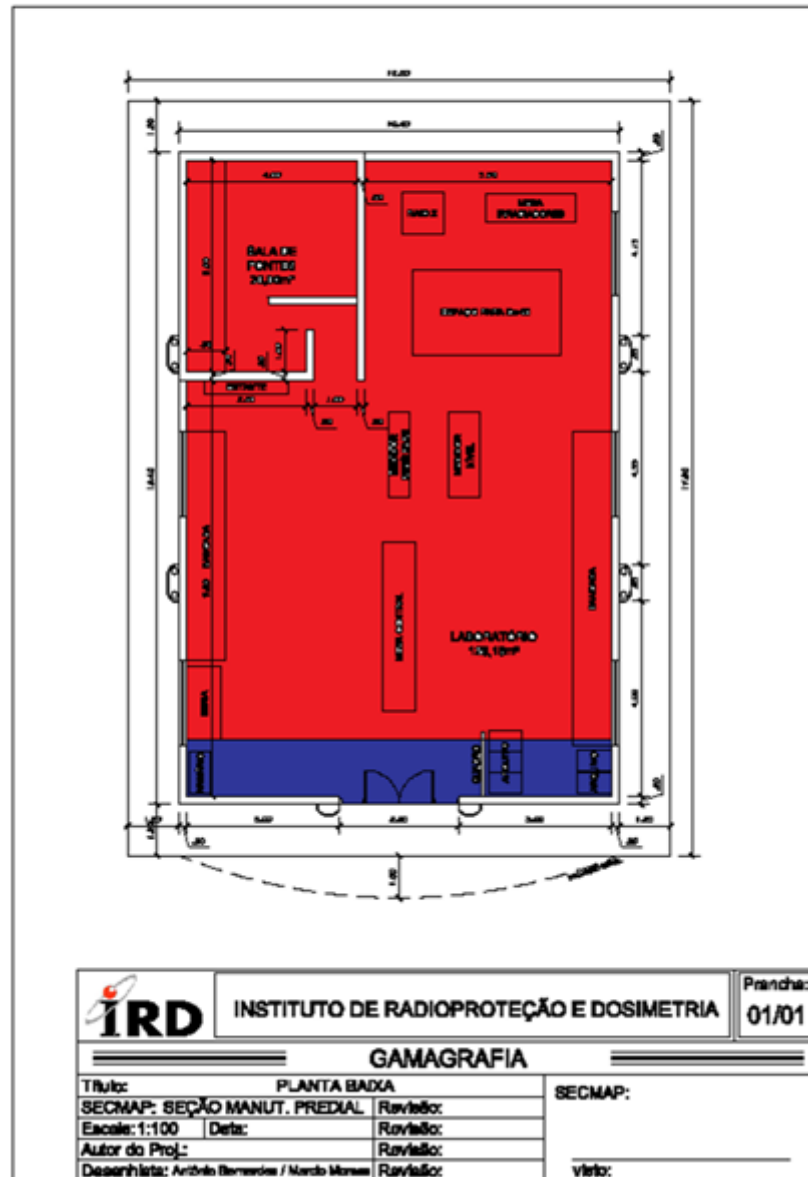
Planta Baixa Laboratório de Gamagrafia.
